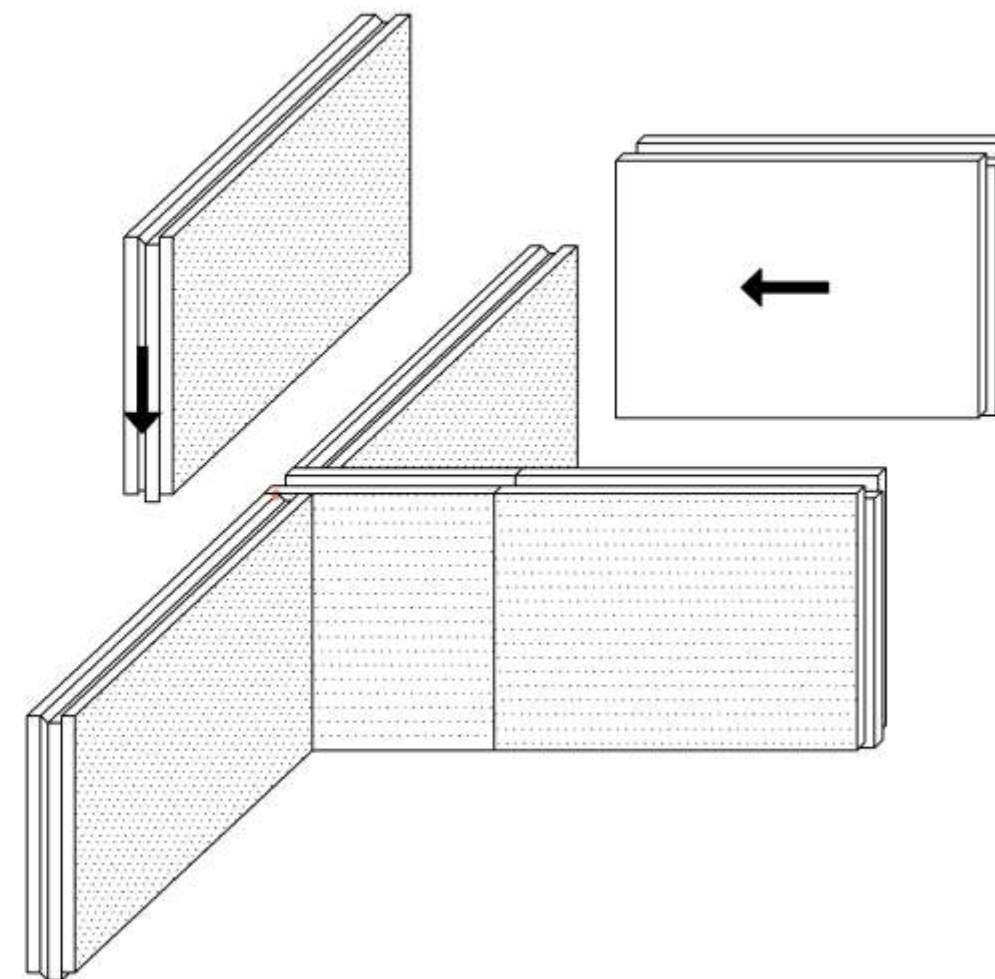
Монтаж плит при пересечении перегородок (облицовок) друг с другом.
